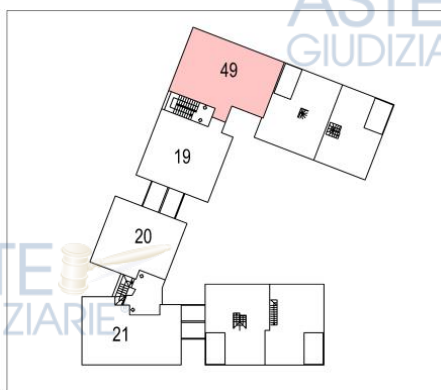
Individuazione della collocazione del subalterno 19 sulla planimetria del piano secondo del condominio
